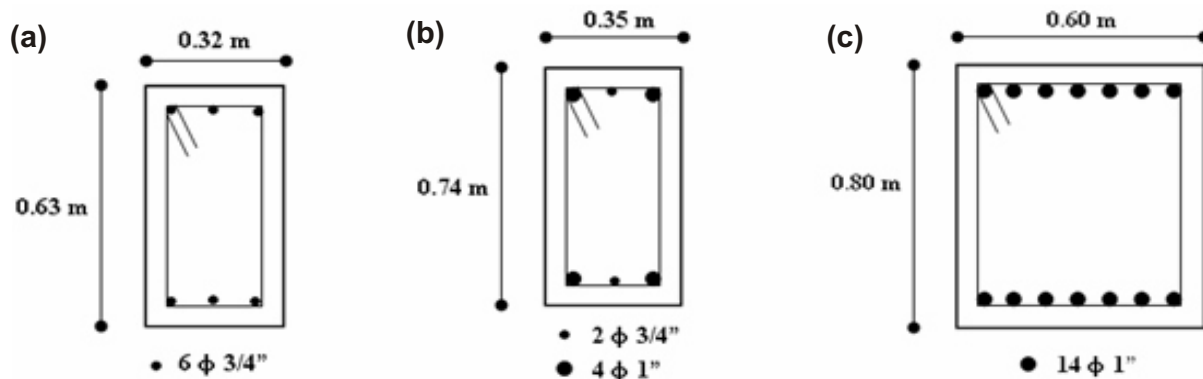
Configuración de secciones transversales de vigas estructurales sin deterioro. (a) Sección Tipo 1. (b) Sección Tipo 2. (c) Sección Tipo 3.
